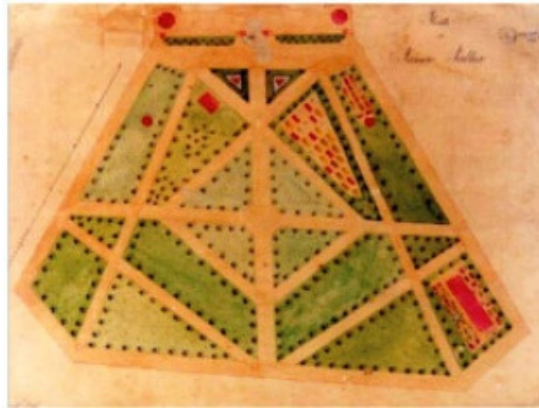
Planta do Passeio Público, (anterior a 1862), desenhada por J. A. Andrade.
